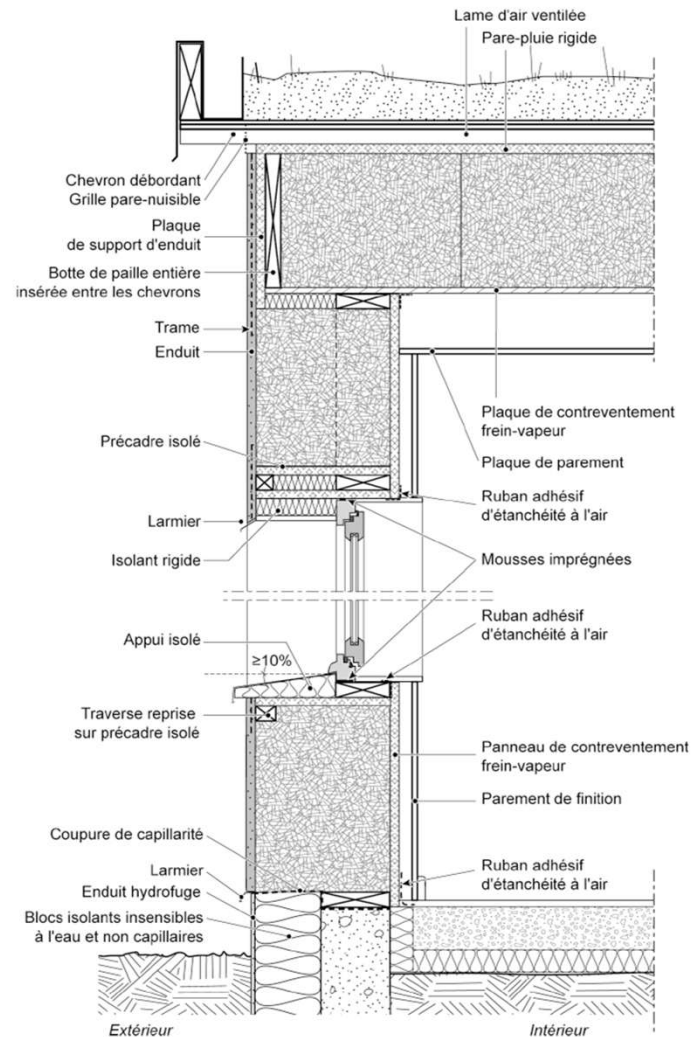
Exemple de coupe verticale d'une paroi avec ossature simple désaxée vers l'intérieur
